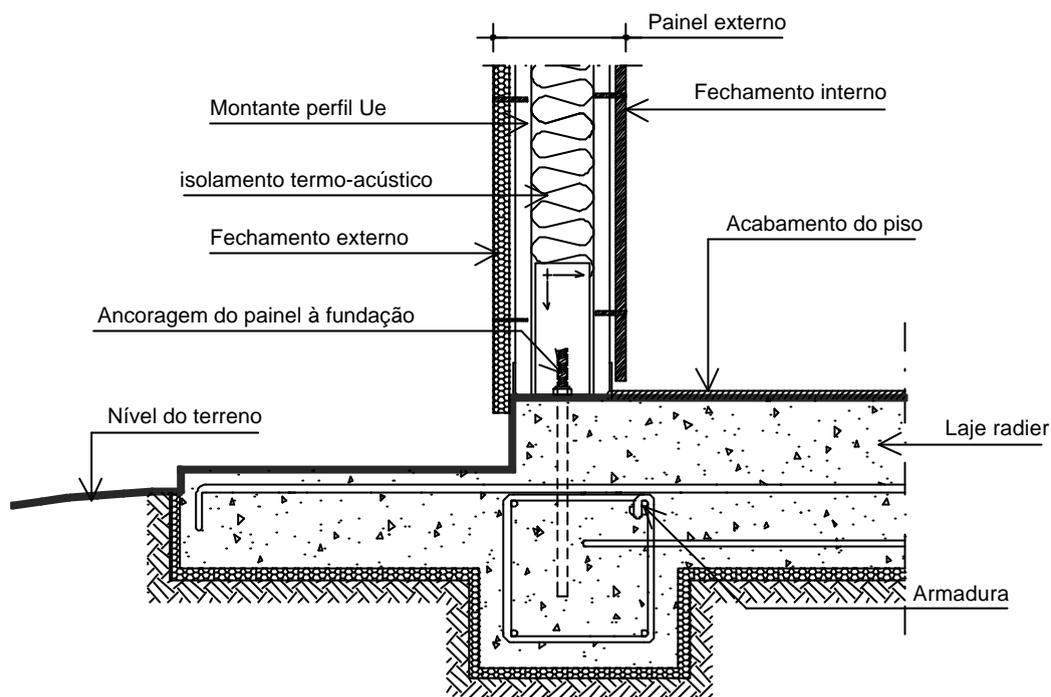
Detalhe esquemático de ancoragem de painel estrutural à uma laje radier
